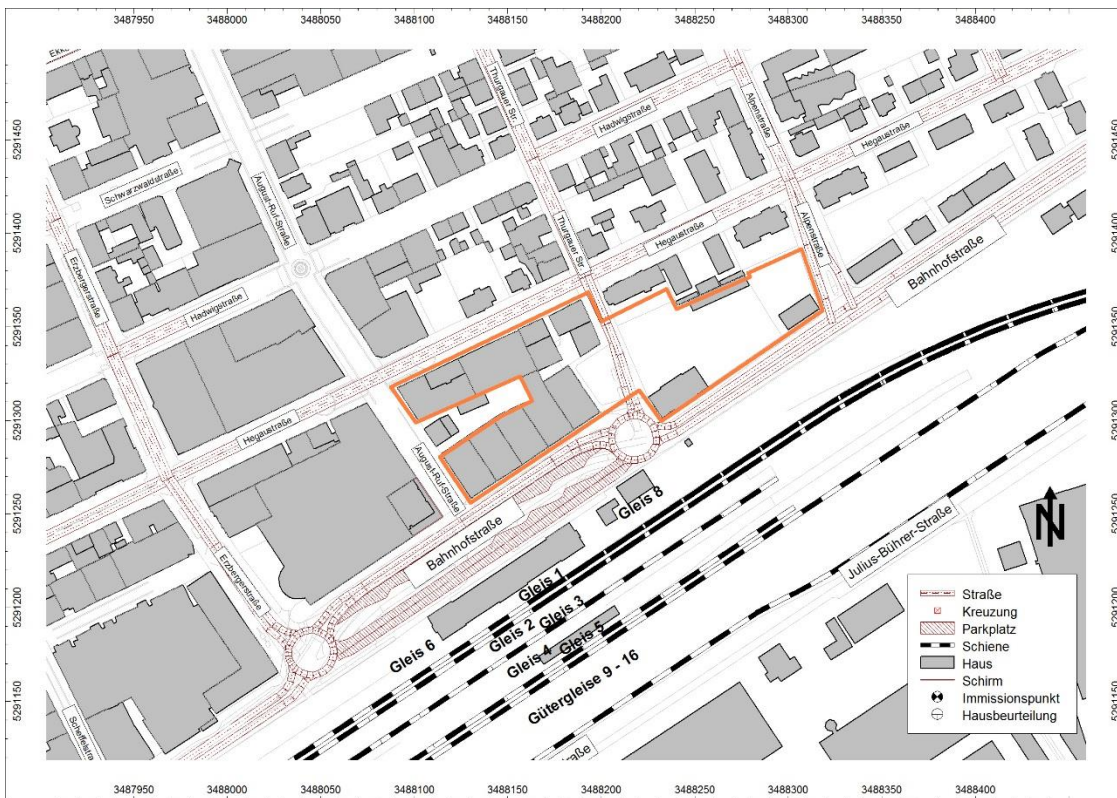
Lageplan Straßenverlauf, Lichtsignalanlagen und Bebauung im Prognose Nullfall 2030
